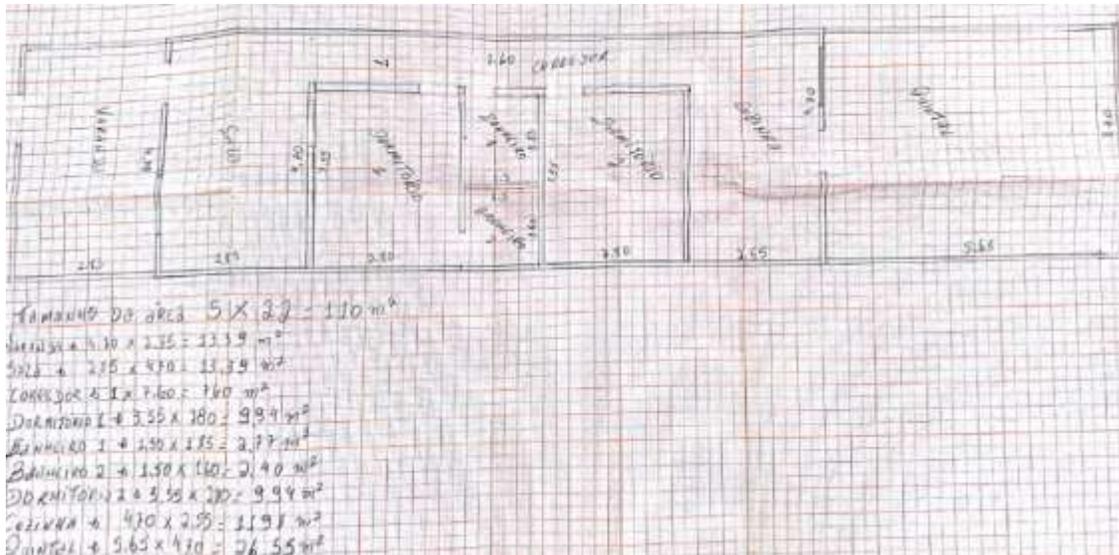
Extrato 1 do E1 Planta Baixa no papel quadriculado
